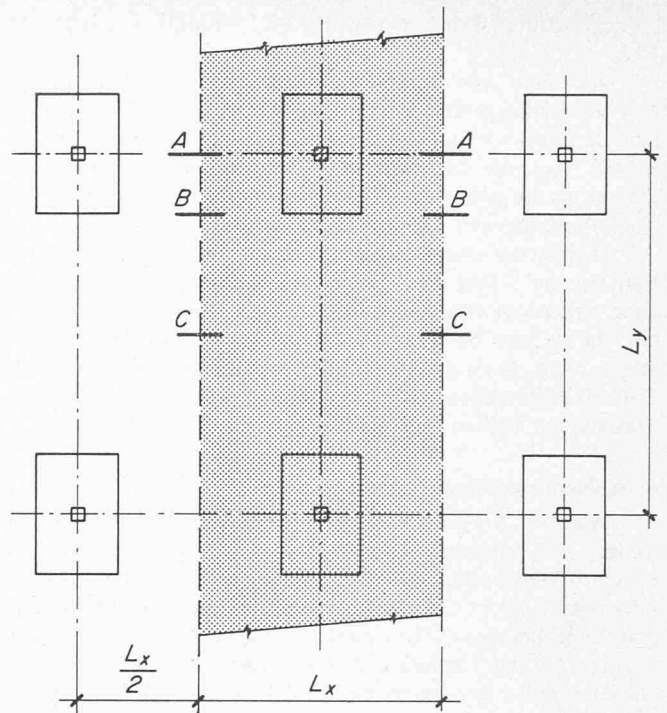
Schemagrundriss mit Schnittbezeichnungen
